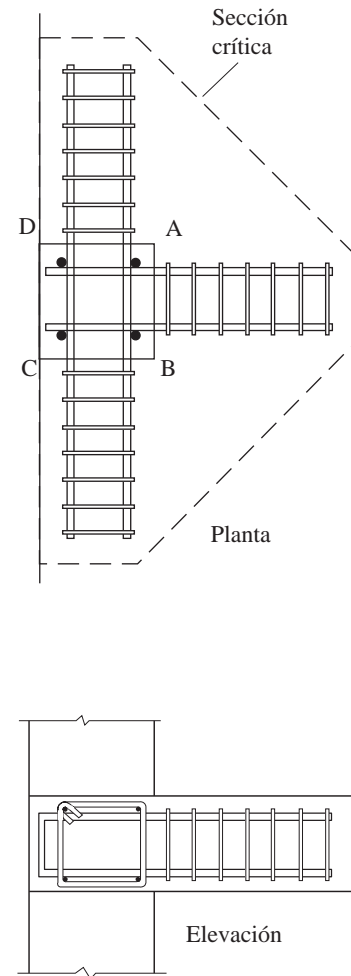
(c) Disposición de estribos de corte, columna de borde.
